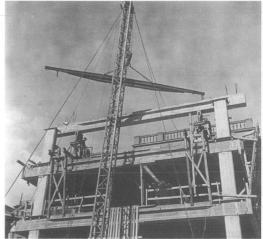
Izado de las vigas postensadas del Edificio Porthania, 1950-1957 (Johansson, Lahti y Paatero 2010)
